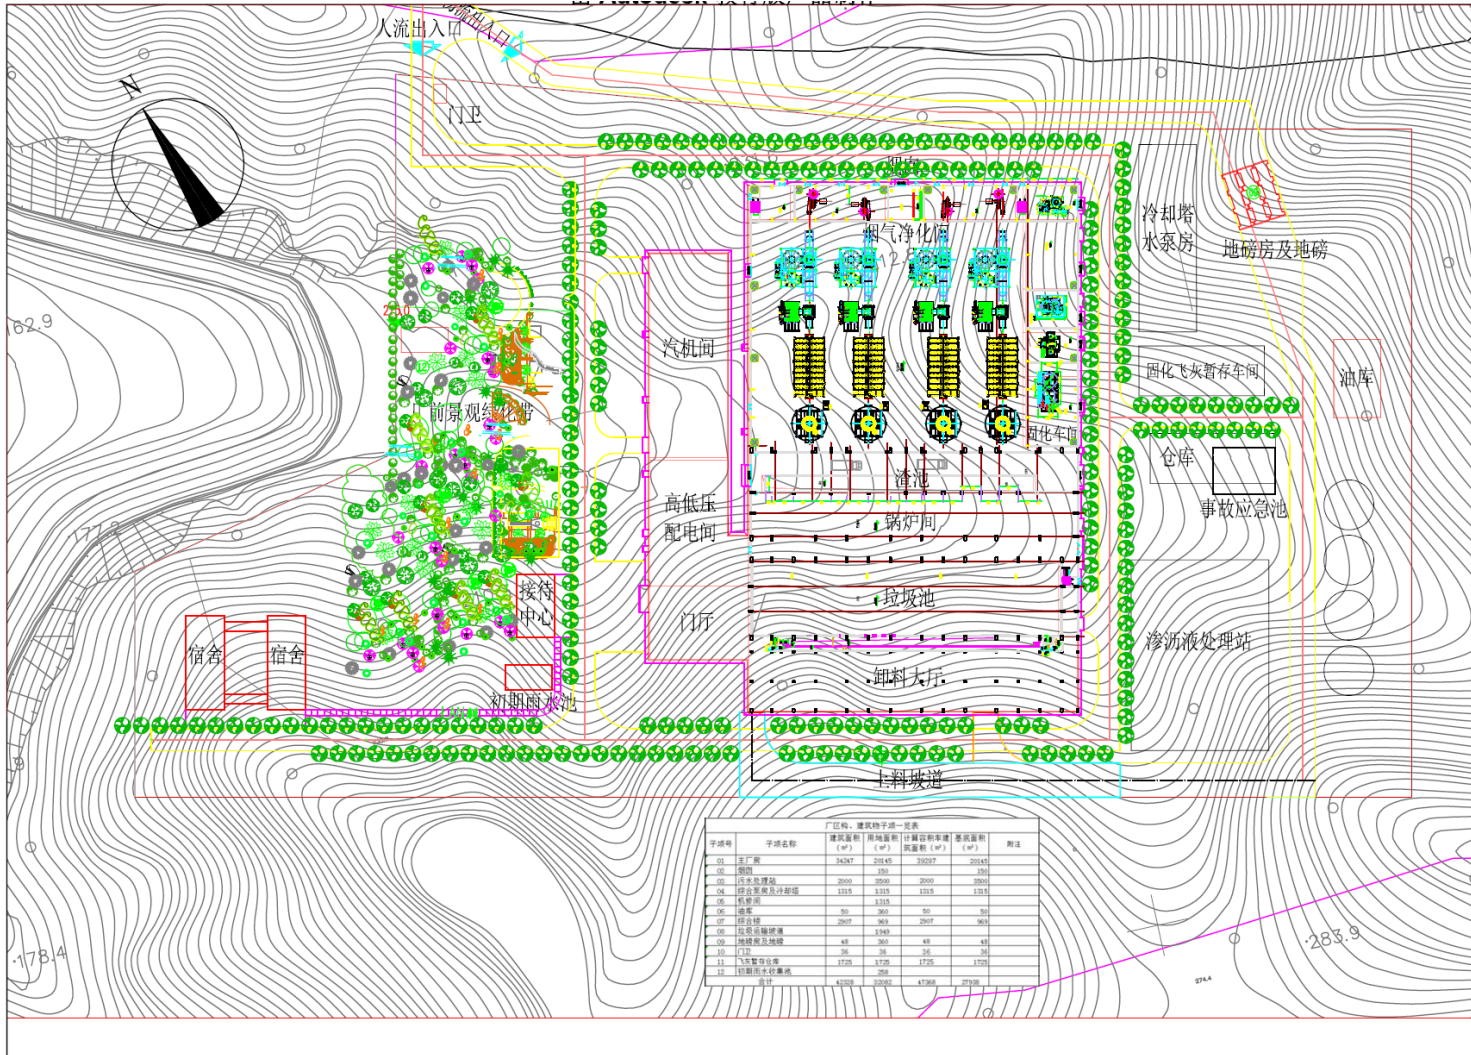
东阳市生活垃圾综合利用项目厂区平面布置图
